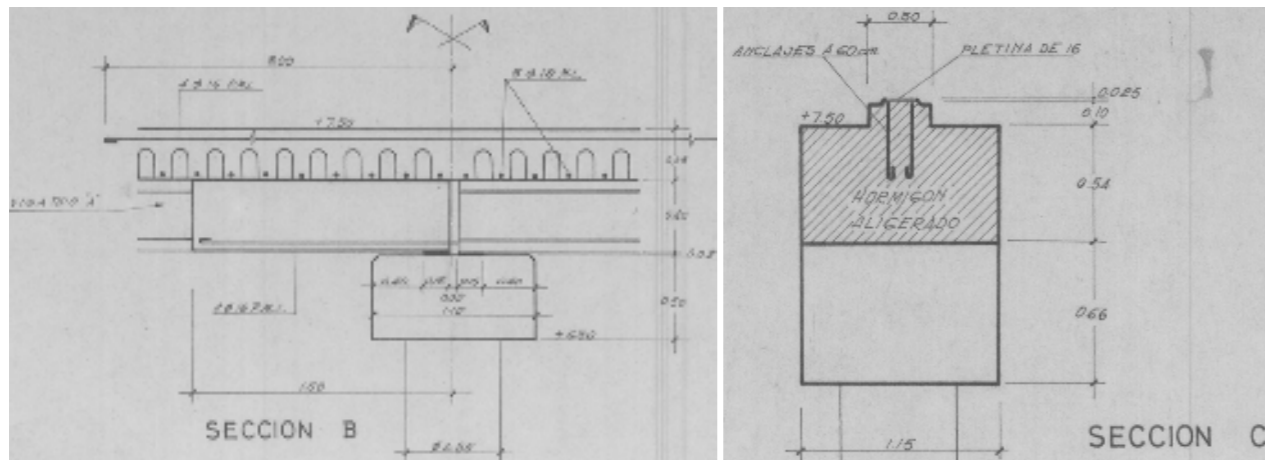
Sección longitudinal del dintel - losa tablero – apoyos
